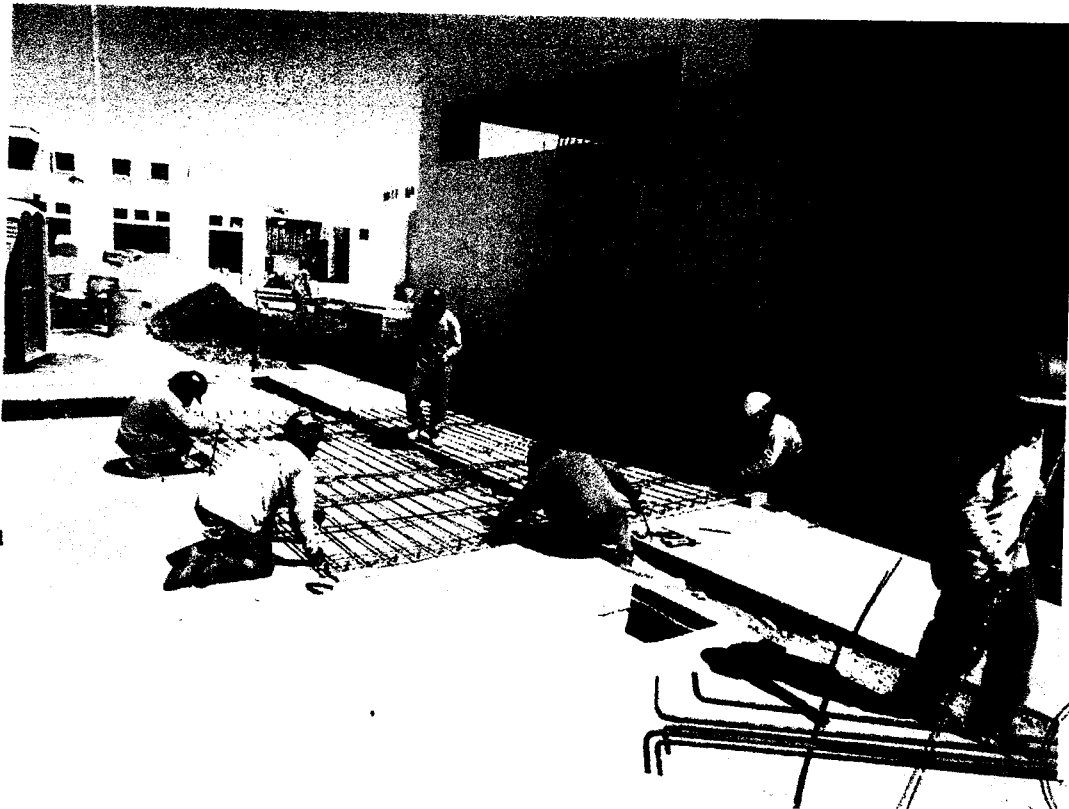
Habilitación de acero, para pavimentos rígidos.
